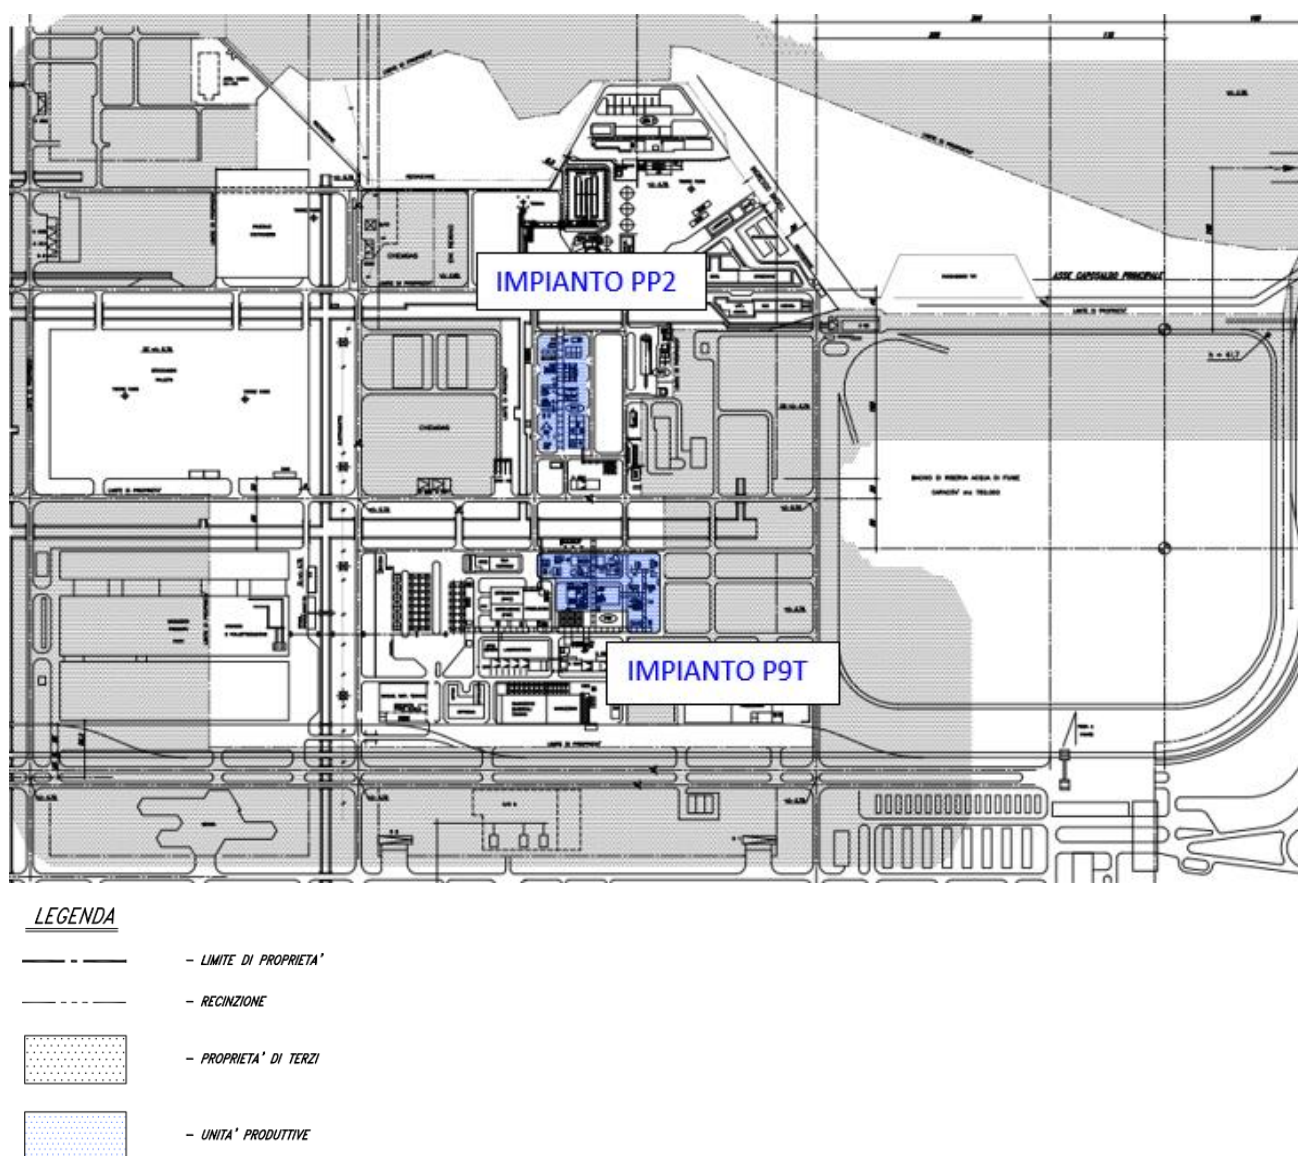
Planimetria dello stabilimento con individuazione delle unità produttive (planimetria fornita da Basell)
